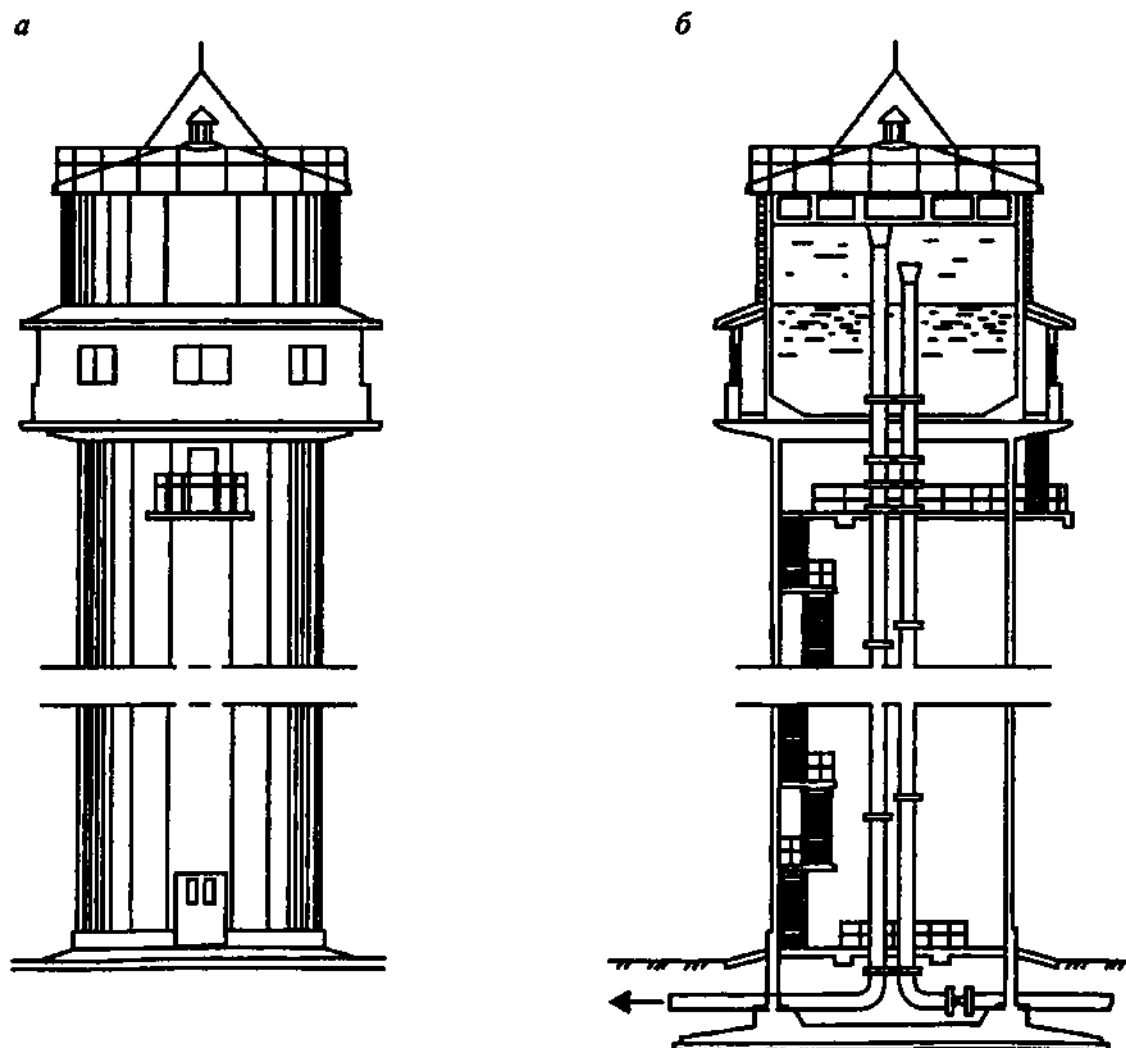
Водонапорная железобетонная башня с железобетонным баком:
